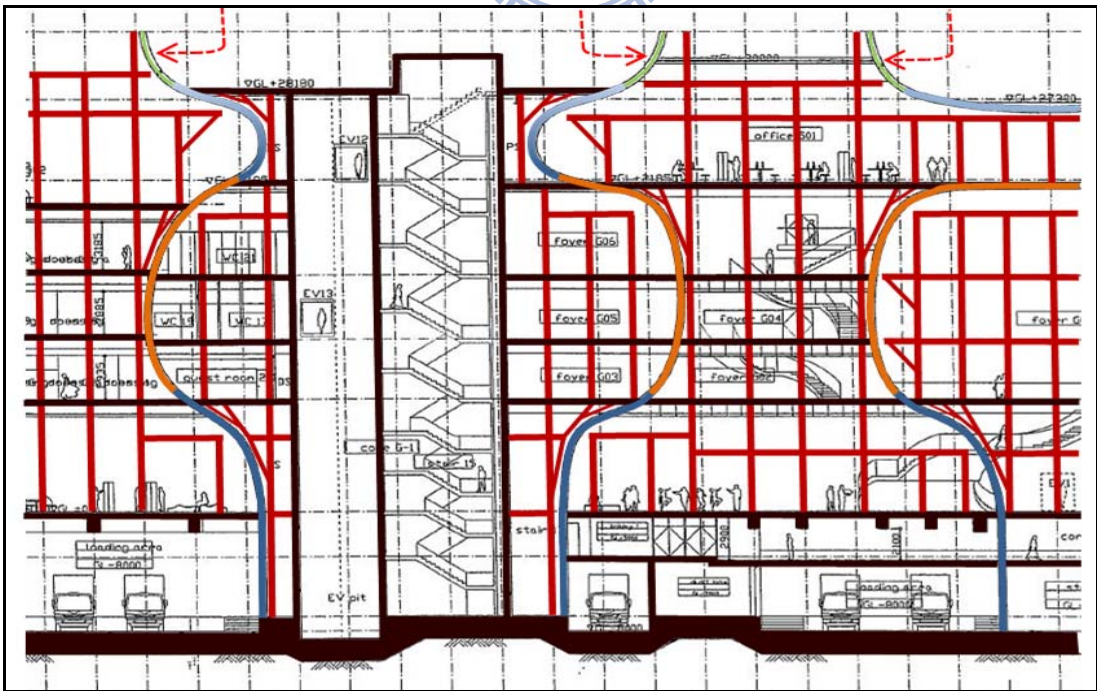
第四層曲牆 Truss wall 鋼筋吊裝
